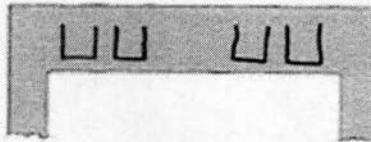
Fisuras de flexión y corrimiento del acero de refuerzo
